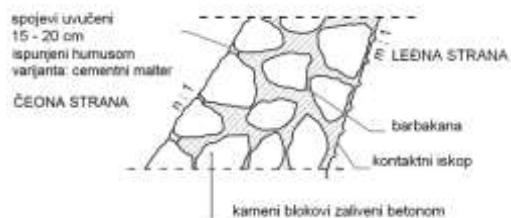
Detalj izvođenja temeljnog betonskog dela
